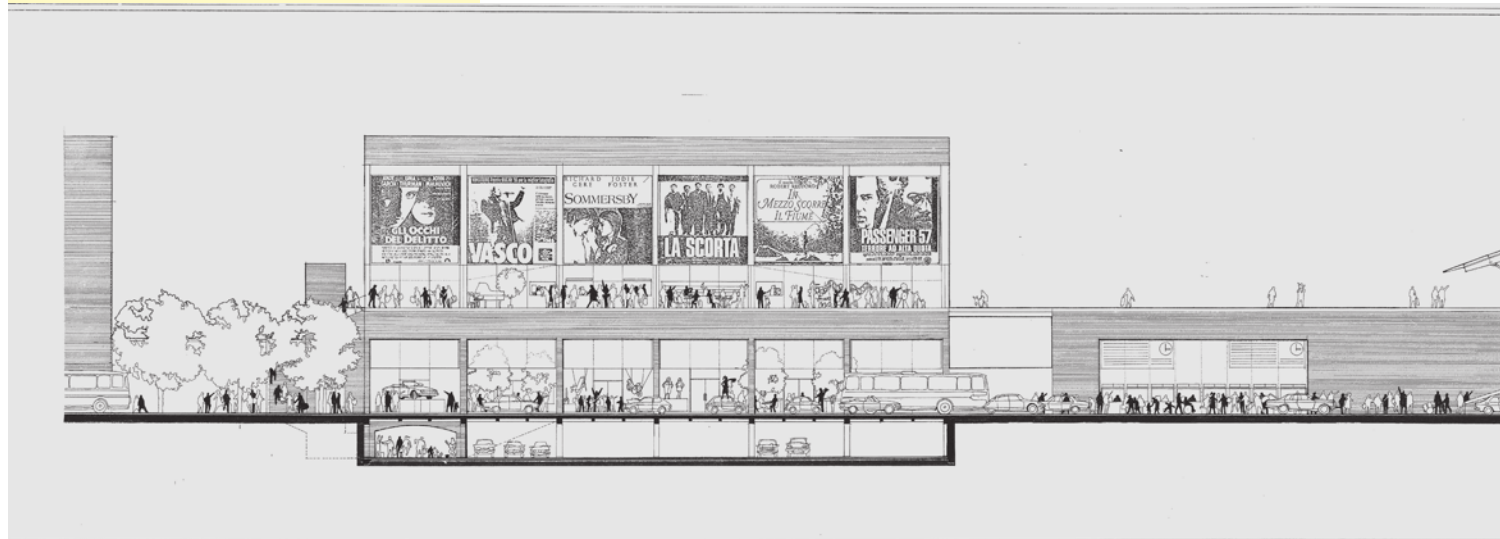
Progetto di stazione a ponte di Mestre: prospetto della stazione verso il lato Mestre.
